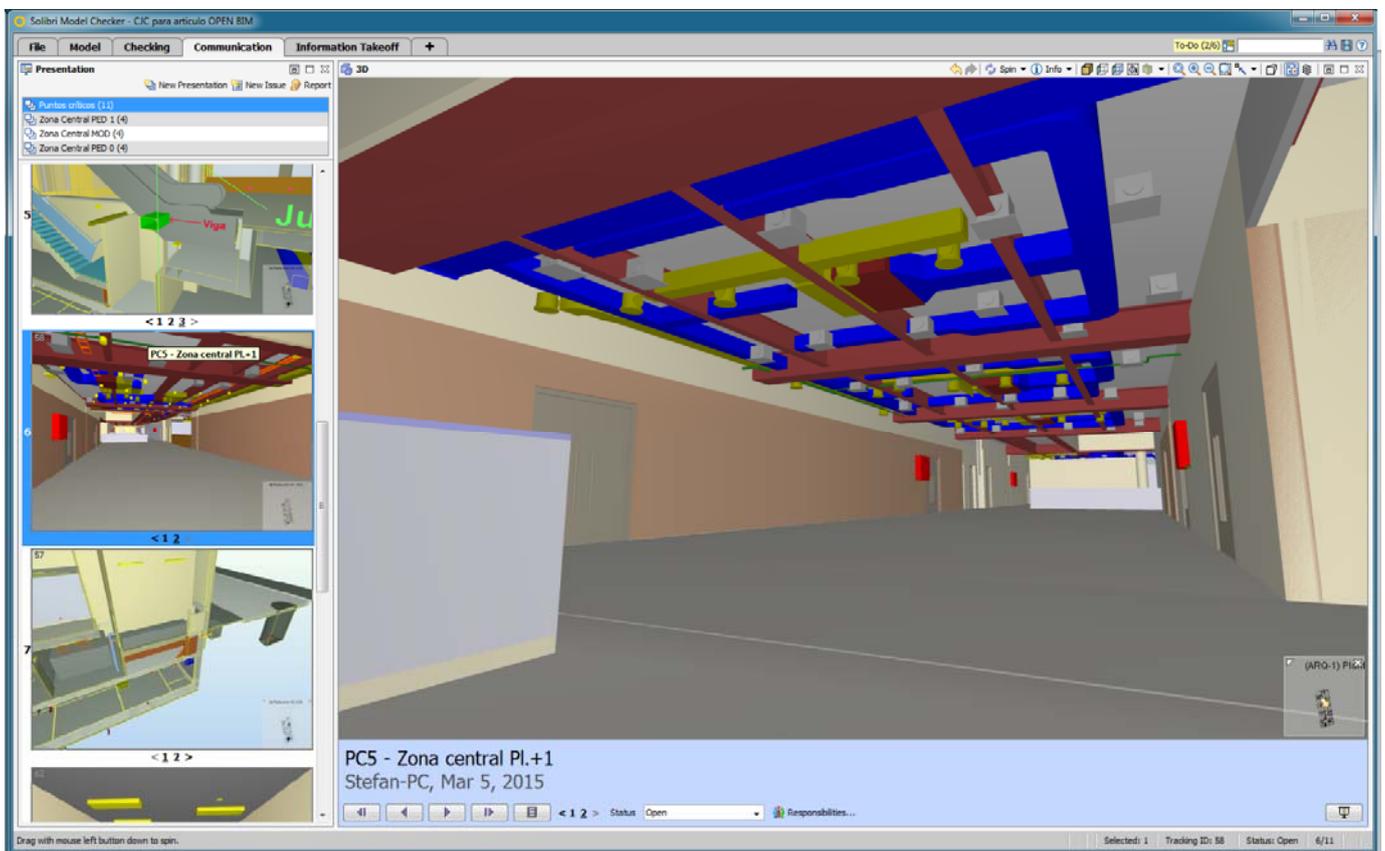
Detección de conflicto entre la estructura metálica de perfiles laminados y las instalaciones de climatización en la zona central de acceso público en planta primera.
